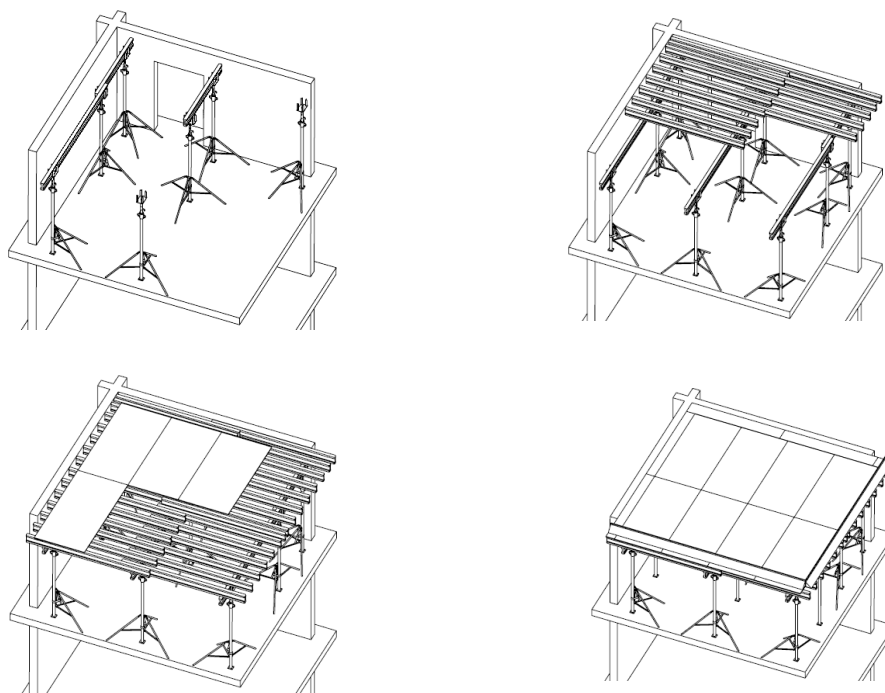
Этапы сборки опалубки перекрытия
